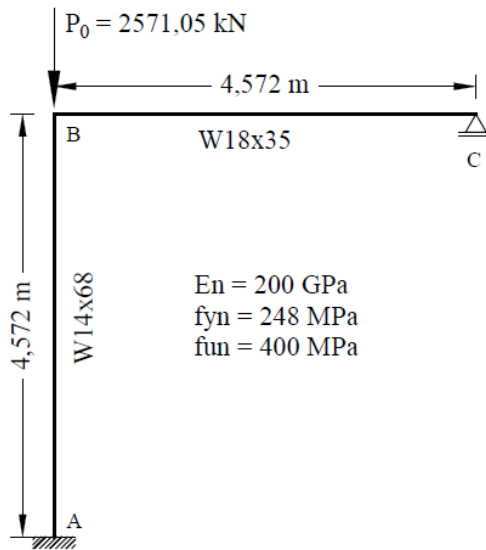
Estrutura 1 – Pórtico Viga-Coluna (Adaptado de Liu, 2019).
